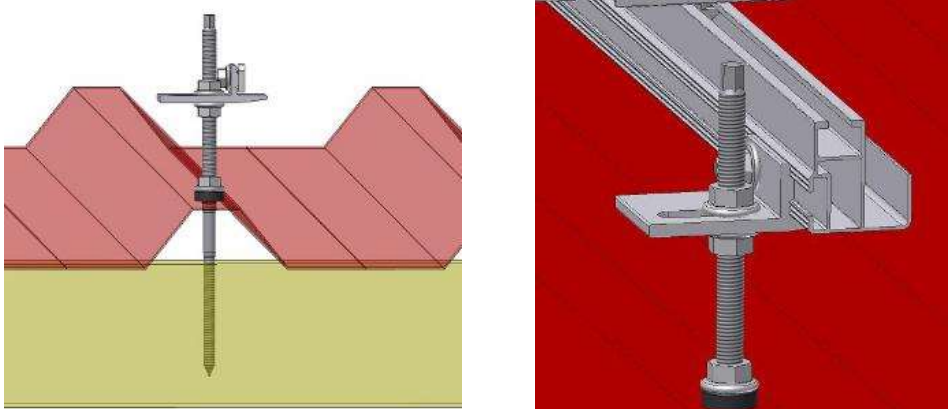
Montierte Stockschraube mit Universalverbinder
